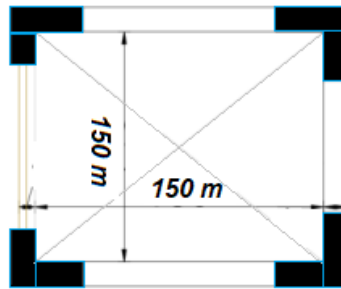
Vue en plan de la dalle d'ascenseur.
